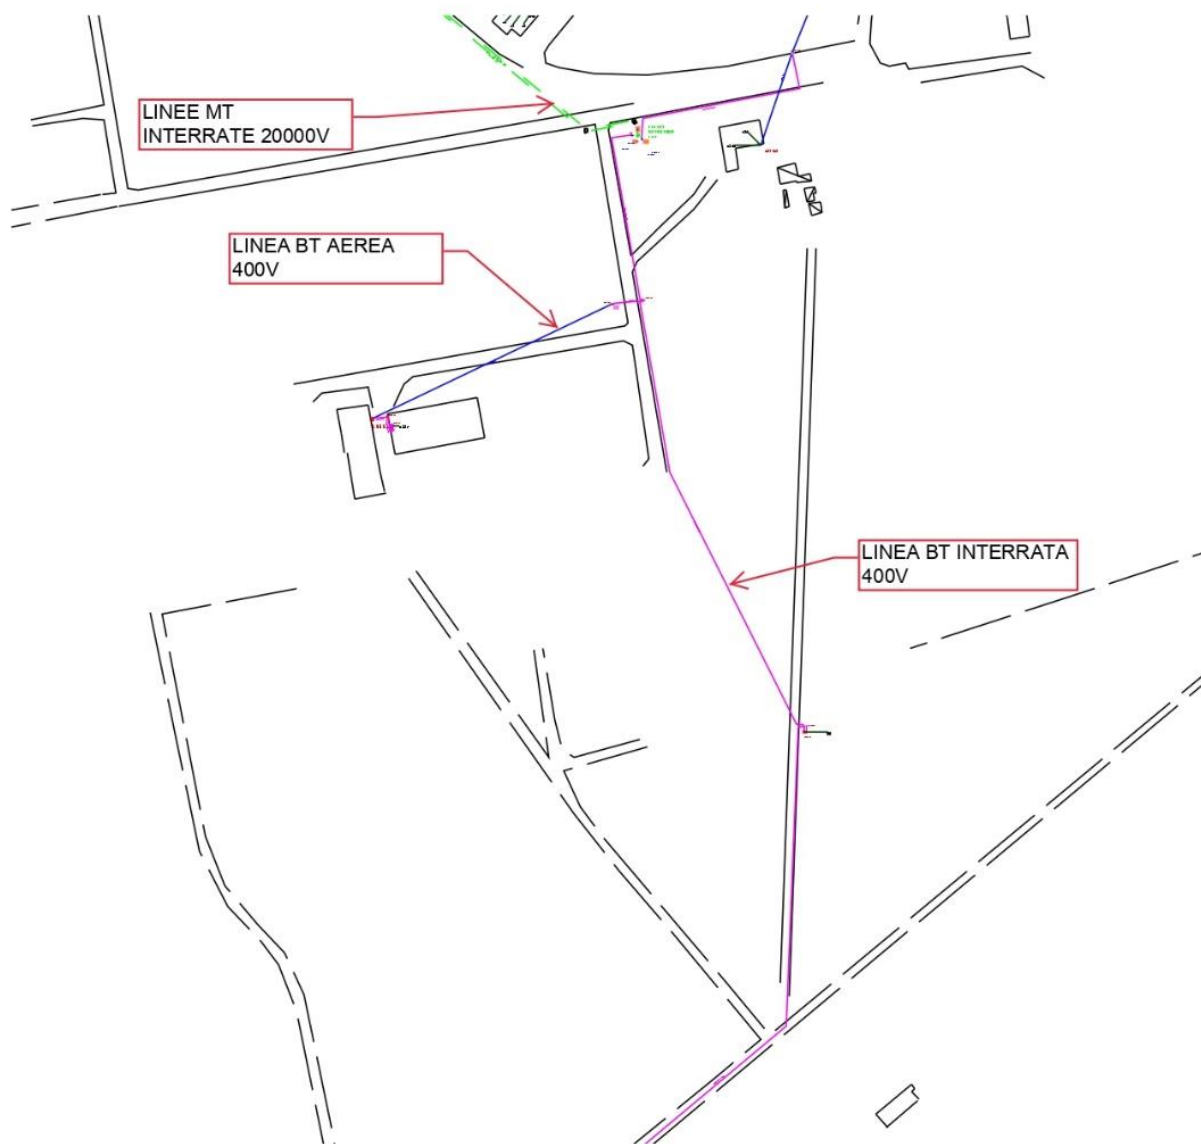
planimetria linee elettriche interferenti (fornita da ENEL)
